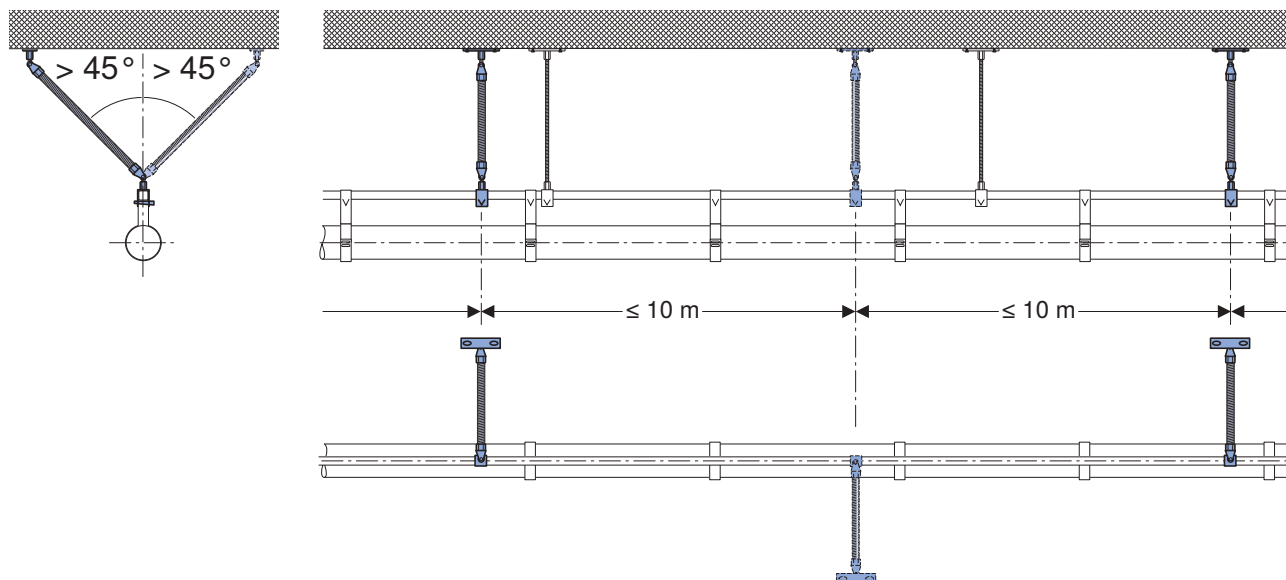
Disposition des kits de fixation de renfort Geberit Pluvia latéralement sur le plafond
